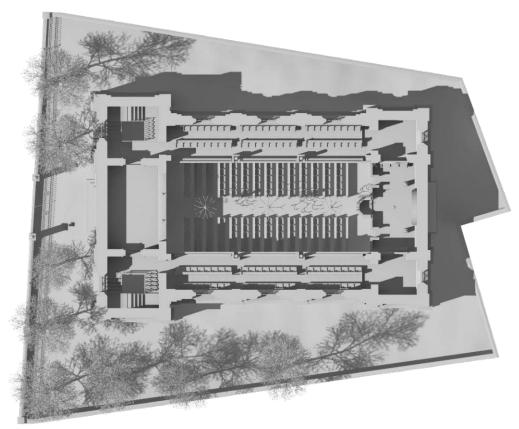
Grundriss Obergeschoss, Weißrendering
